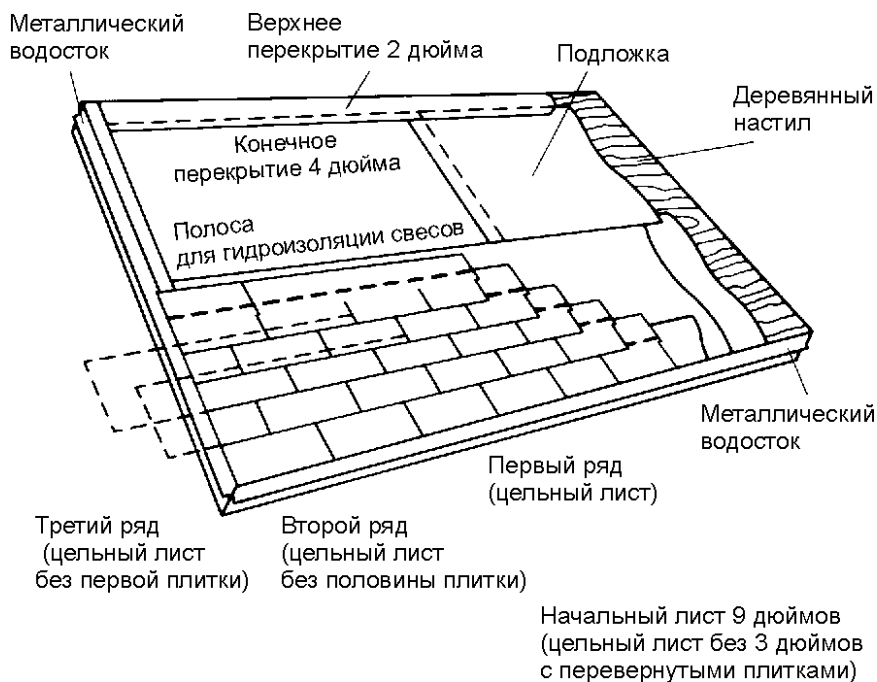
Начало укладки листов рубероидной плитки от фронтонного свеса (Bird and Son)
